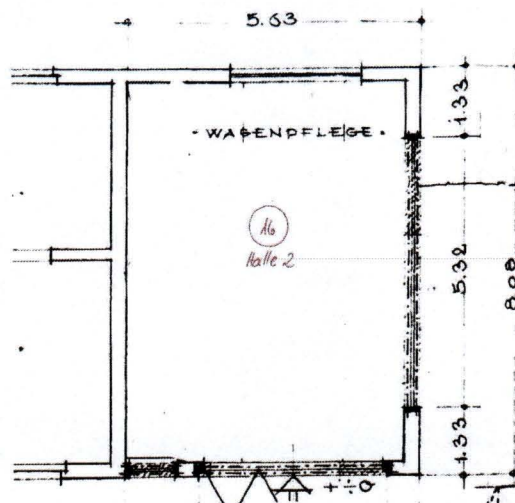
Grundriss Halle 2 (EG, straßenseitig)
